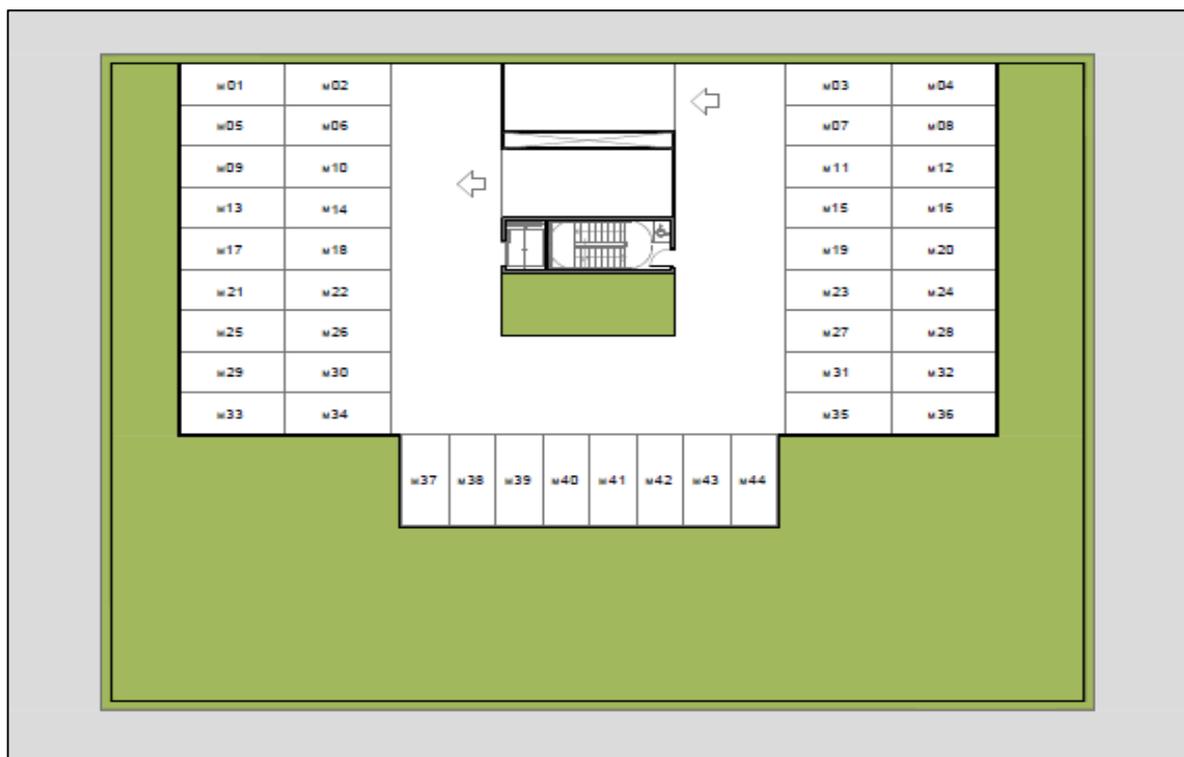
Planta da cobertura da edificação, contendo 44 vagas e área para cobertura vegetal.
